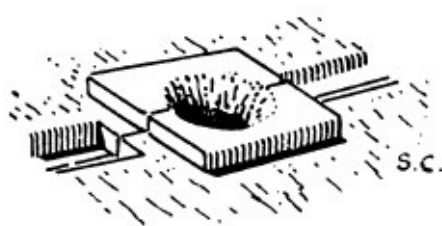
Вентиляционное отверстие между двумя плитами крыши. Храм Сети I в Абидосе
